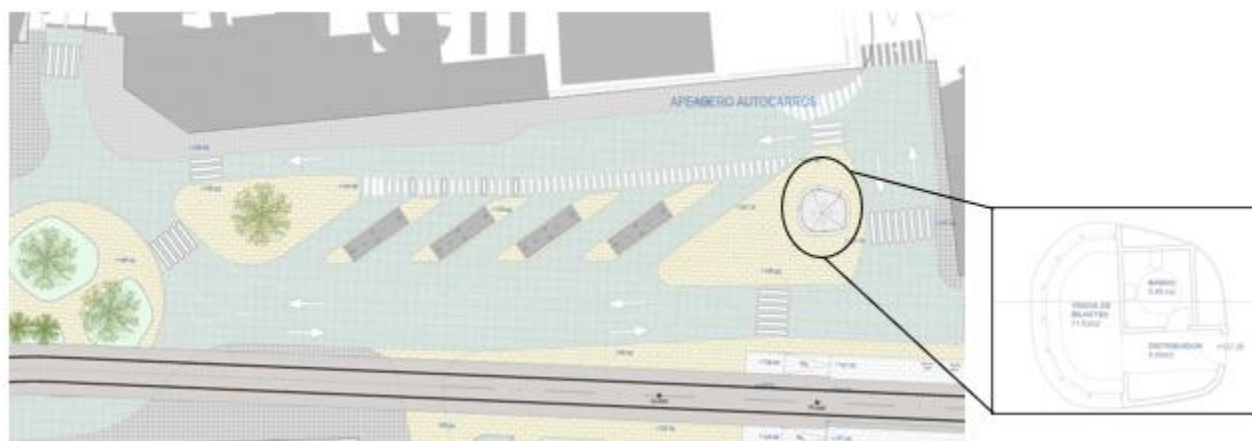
Planta Terminal de autocarros e planta da loja Andante
